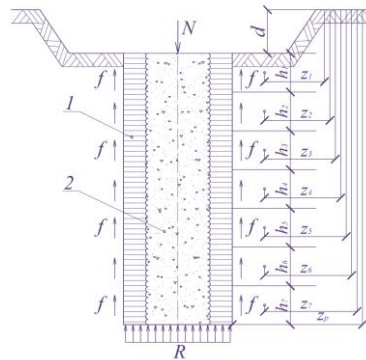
Схема к определению несущей способности сваи SFA (НПШ) совместно с грунтоцементным массивом по грунту (грунтобетонные сваи (ГБС): 1-грунтоцементный массив, 2 – свая SFA (НПШ)
